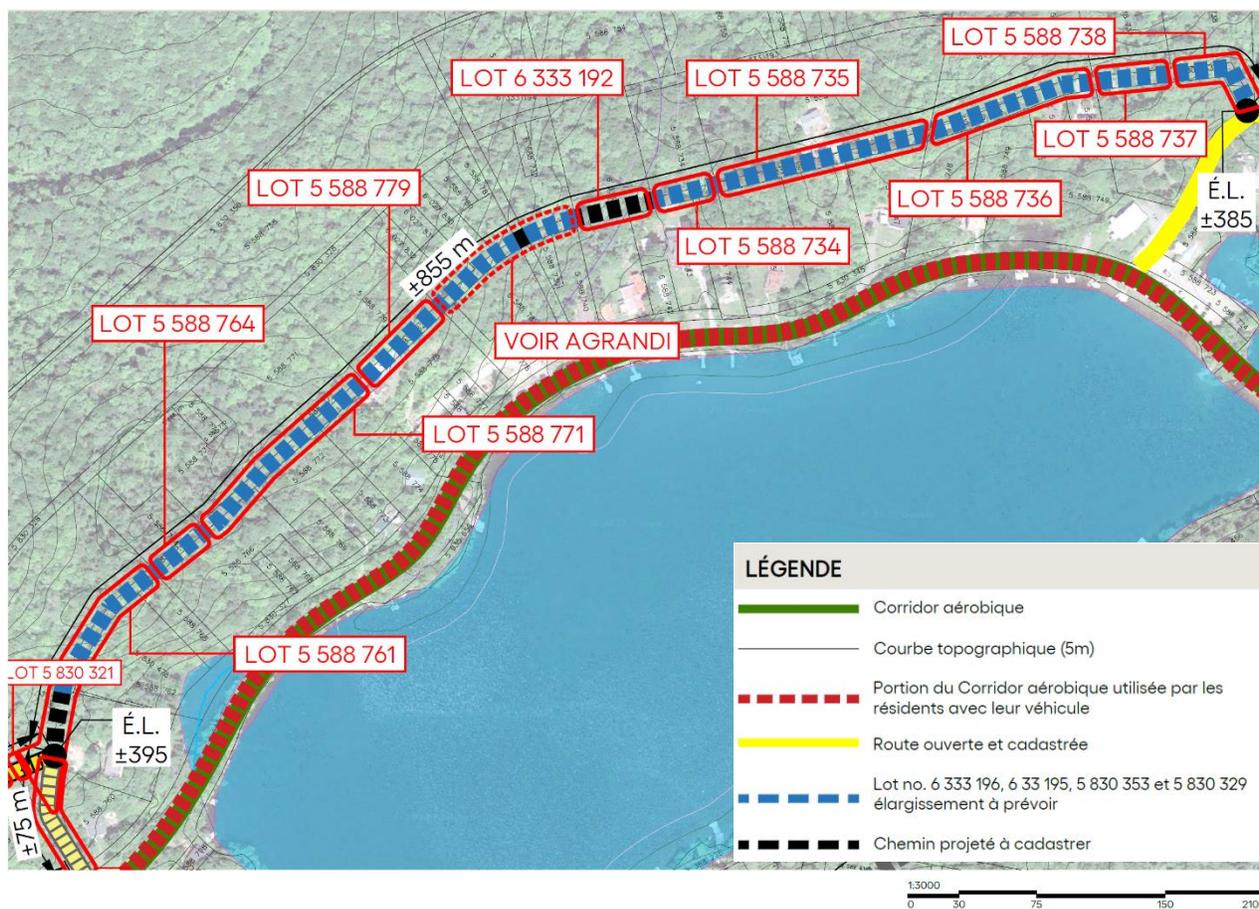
Agrandi du plan de la figure 7 - Section de lots touchés par le raccordement
